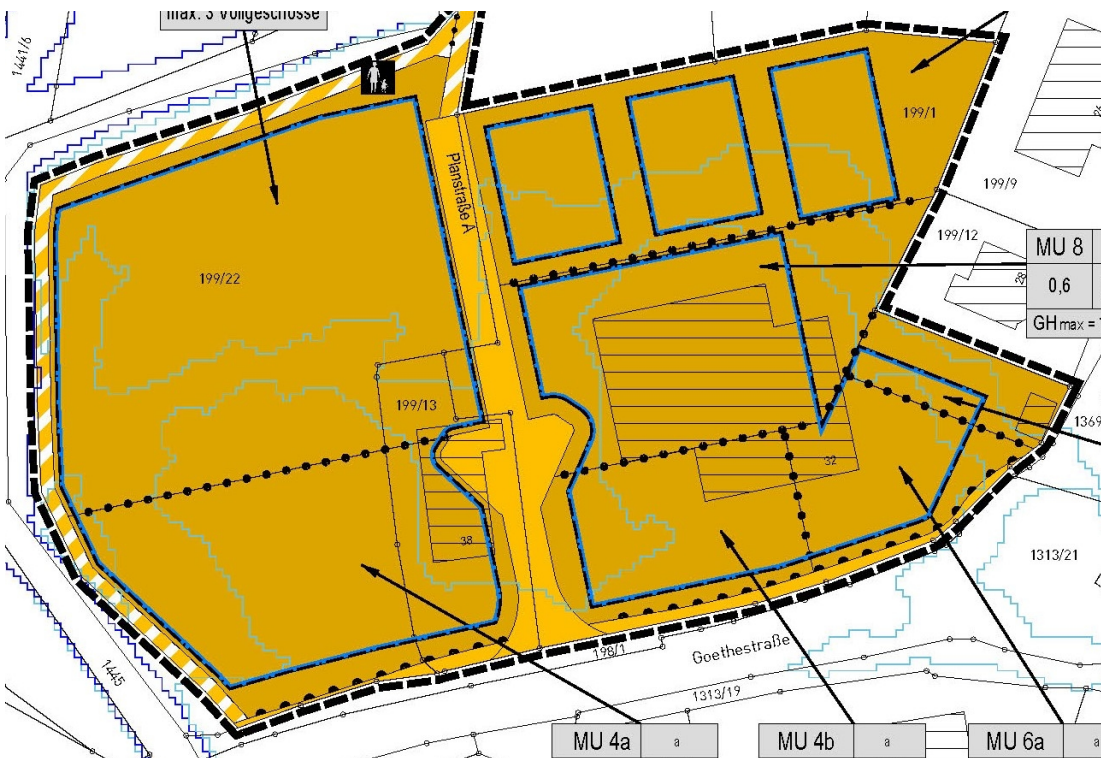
Vorliegender Bebauungsplan „Goethestraße – 1. Änderung“ (Ausschnitt)
